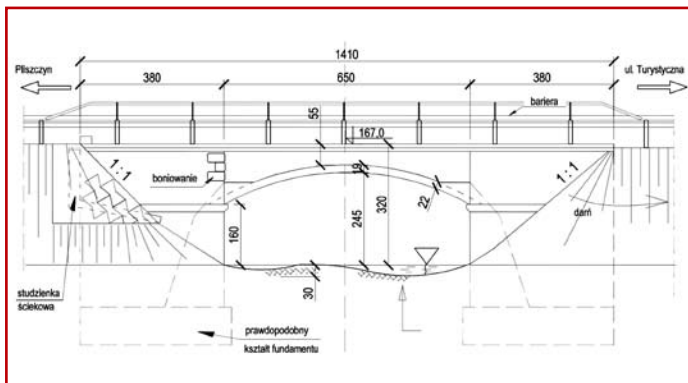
Inwentaryzacja. Przekrój poprzeczny
